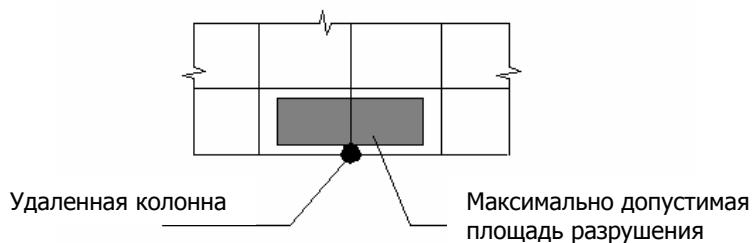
Схема предельно допустимого разрушения плиты перекрытия в крайних пролетах
